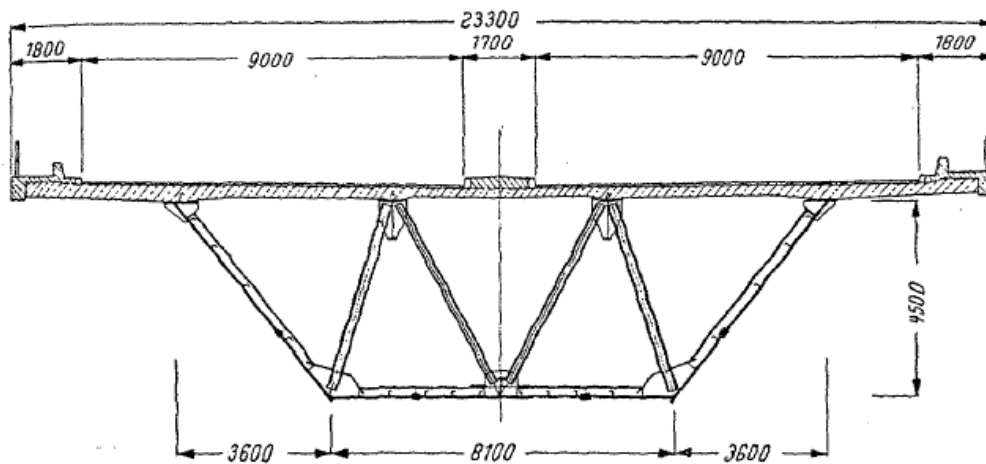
Secção transversal da ponte de Wuppertal [1]
